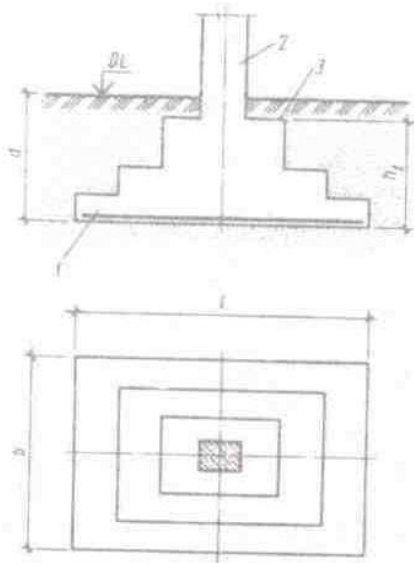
Схема фундаменту мілкого закладання: 1– фундамент; 2 – колона; 3 – уступ фундаменту
